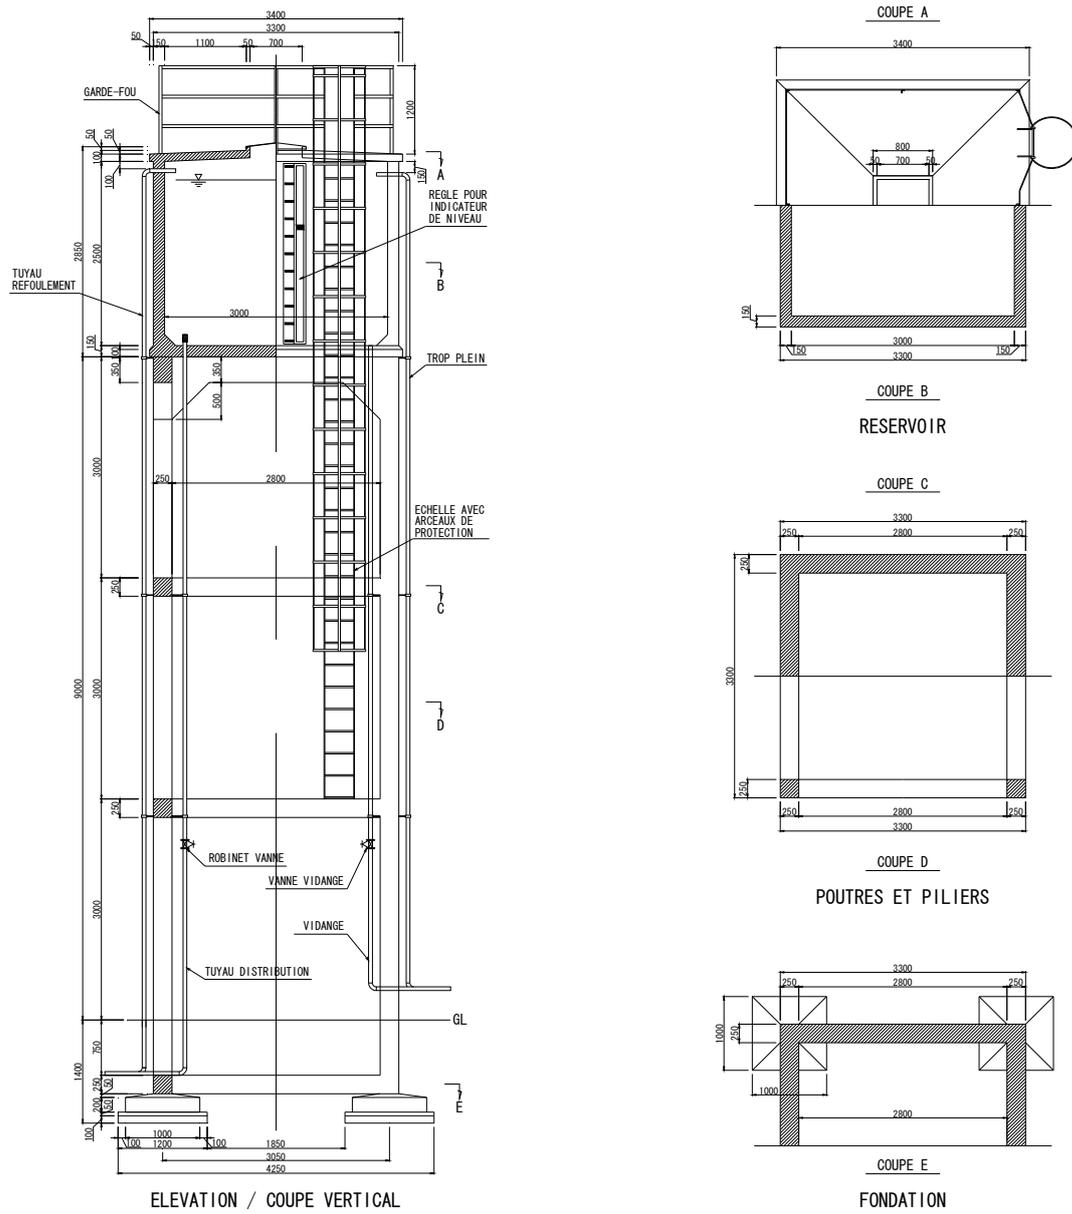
Plan structural de réservoir surélevé 20 m³ H= 9 m
